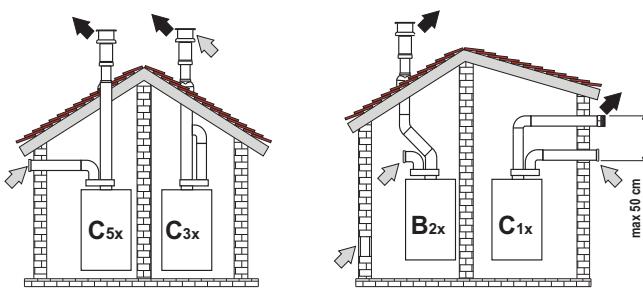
Esempi di collegamento con tubi separati (➡ = Aria / ➡ = Fumi)
